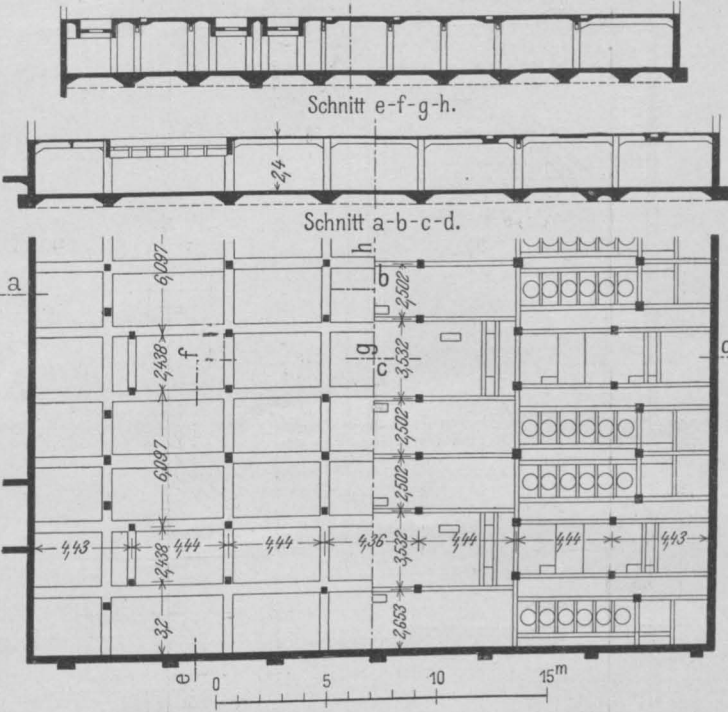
Grundriß und Schnitte durch das Untergeschoß des Presssaales.
